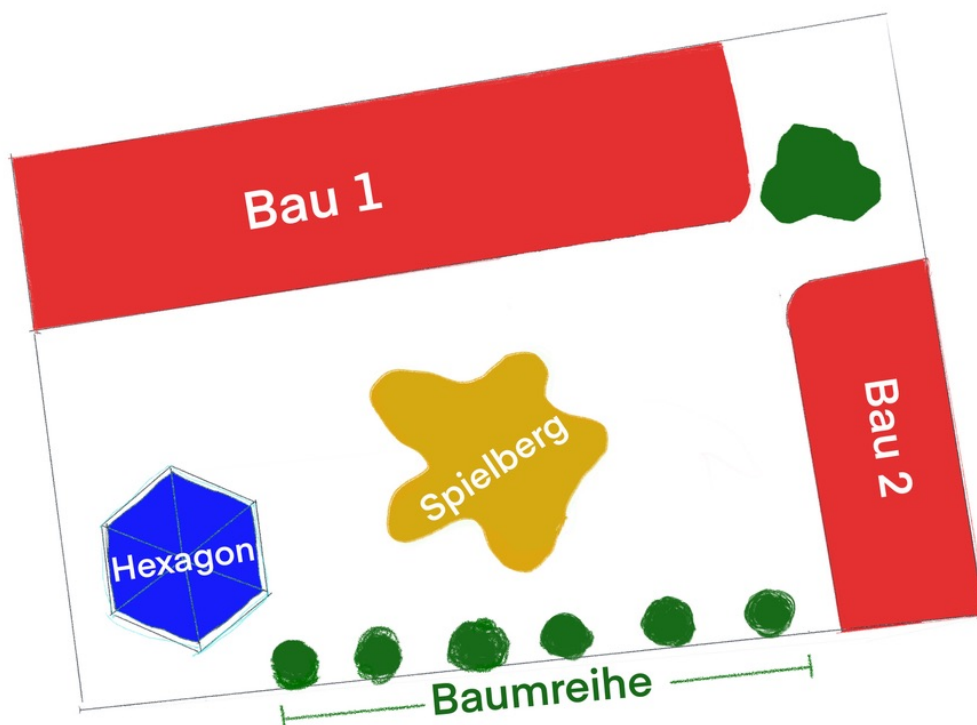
Grundriss der Gebäudeverteilung
